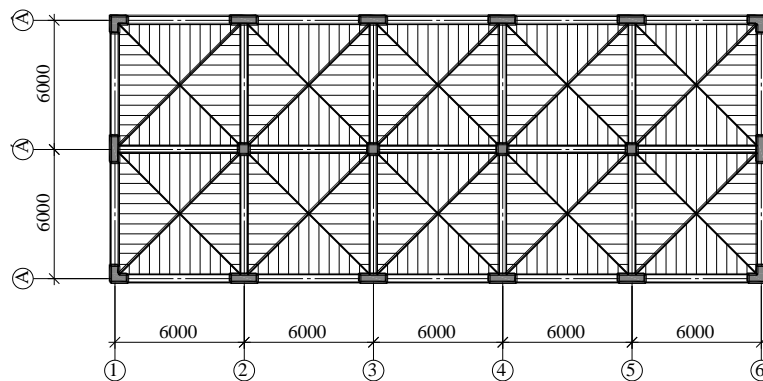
Принципиальная схема, в соответствии с которой веса неучтенных участков перекрытий и приложенных к ним нагрузок передавались на балки
